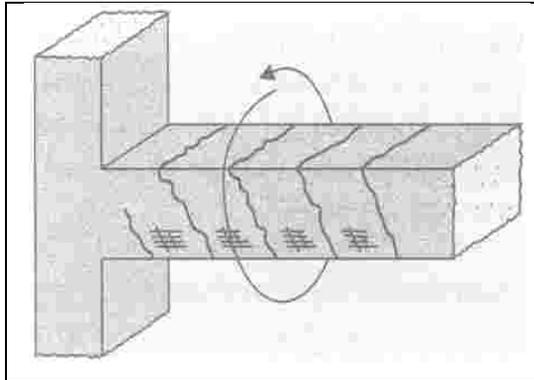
Fisuras inclinadas en los extremos de la viga por torsión¹⁵
